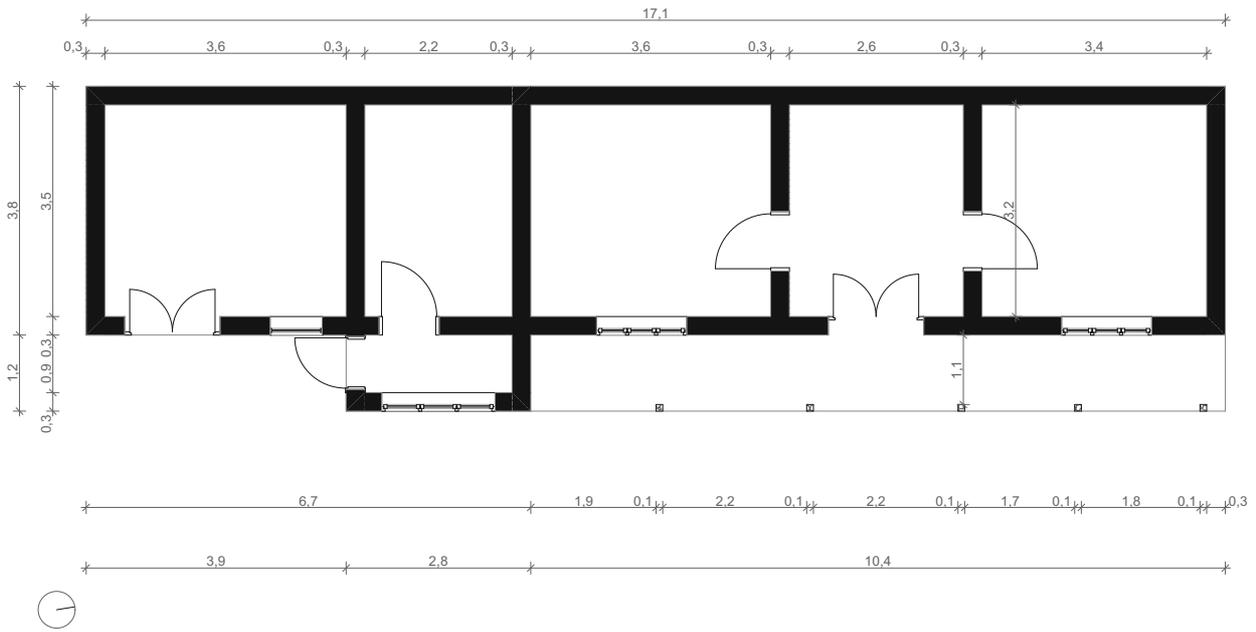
Pläne Haus Stoicani (Grundriss, Ansicht)
